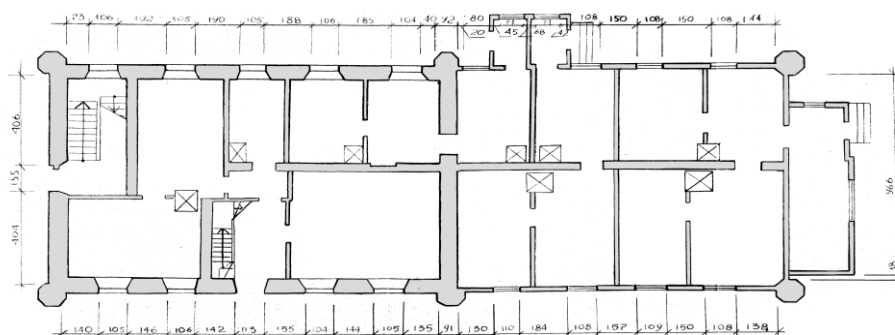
Схема плана 1-го этажа флигеля и пристройки
